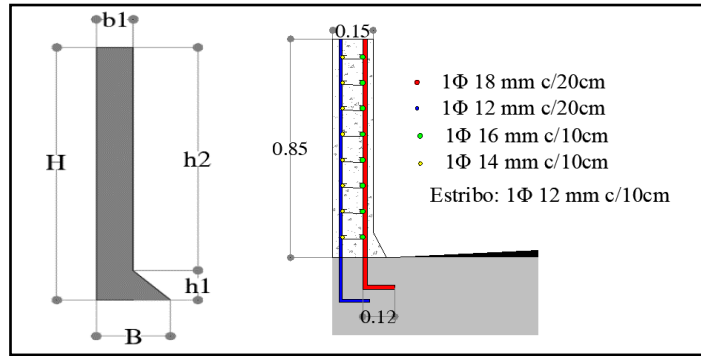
Dimensiones y armado inicial propuesto para la protección lateral maciza
